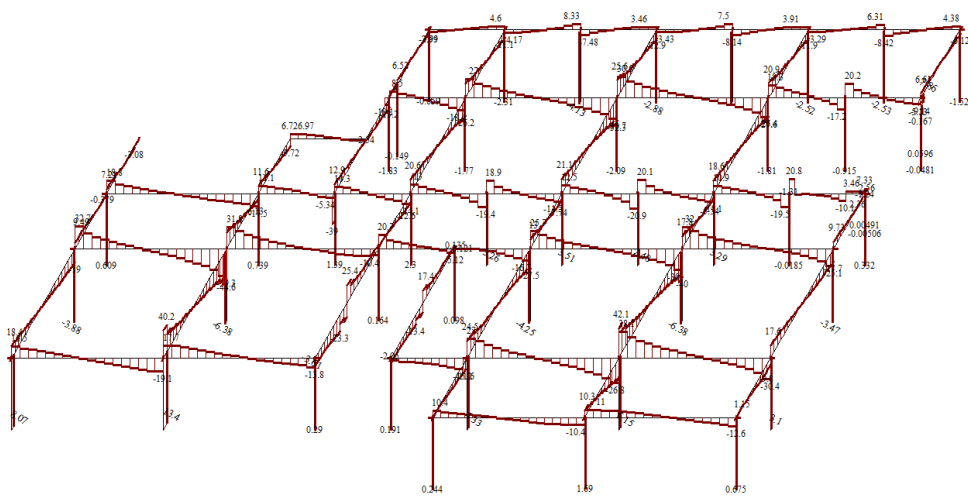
Усилия  $Q_z$  в балках перекрытия
